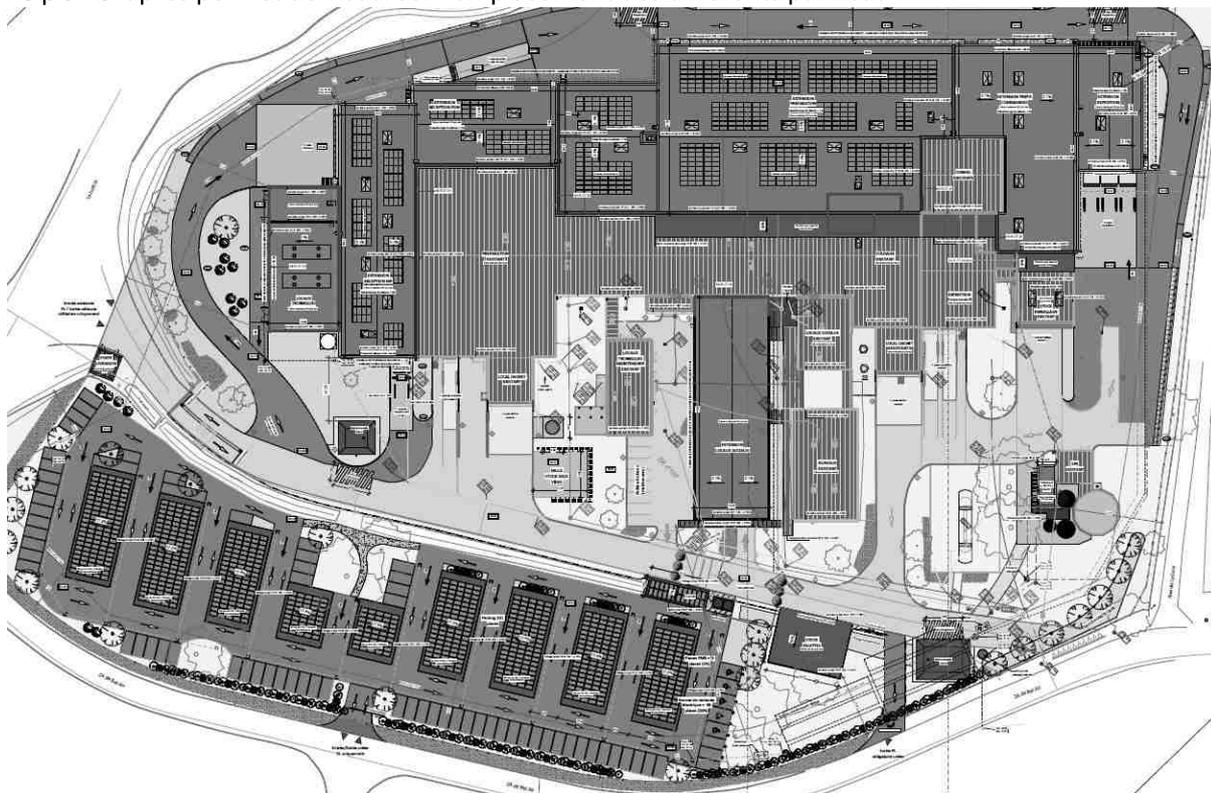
Plan masse avec emplacement des panneaux solaires photovoltaïques
